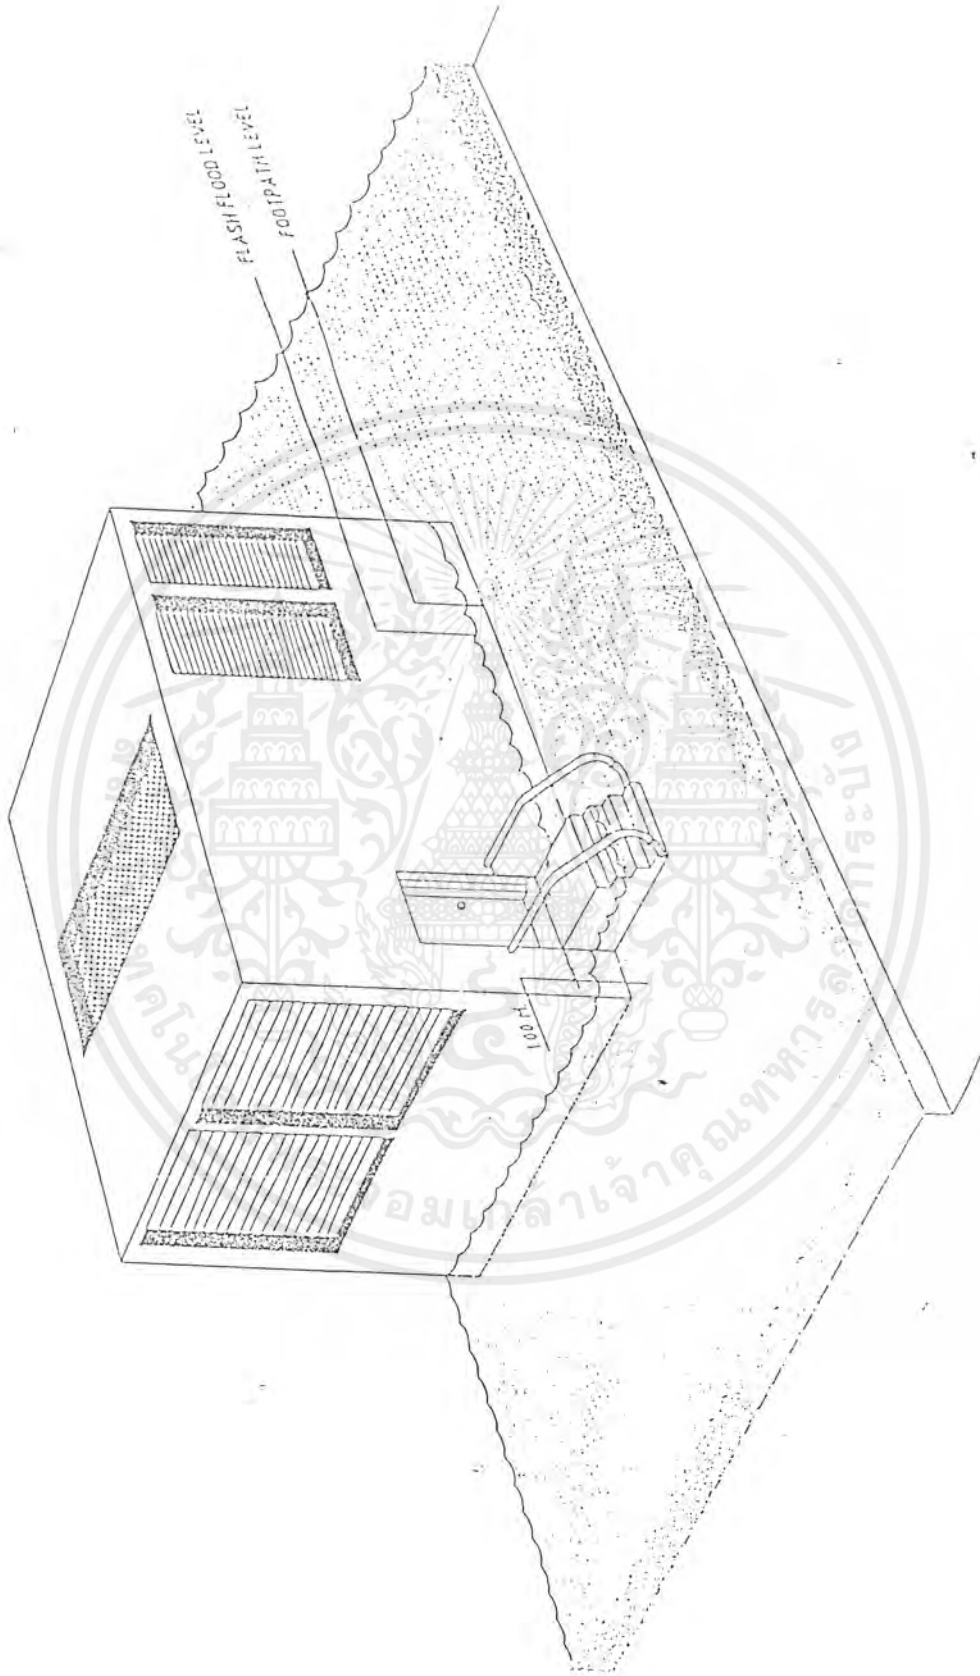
STATION FLOOD PROTECTION AND WATERPROOFING
